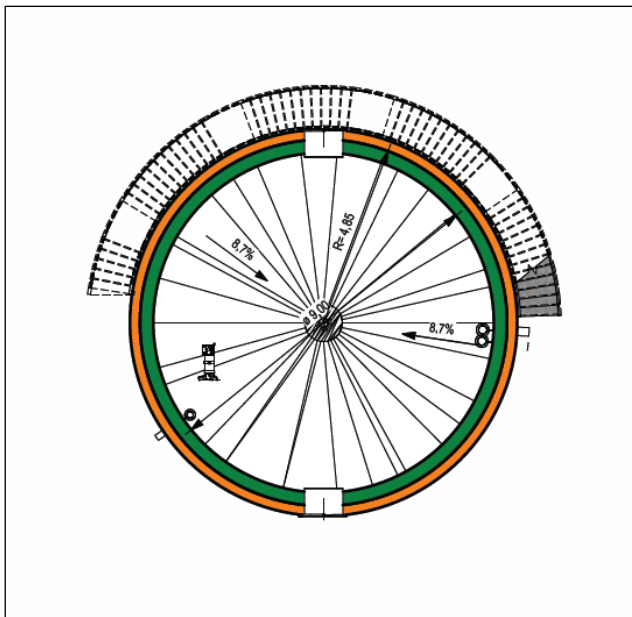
Grundriss EG Faulschlamm-speicher (o. M.)
